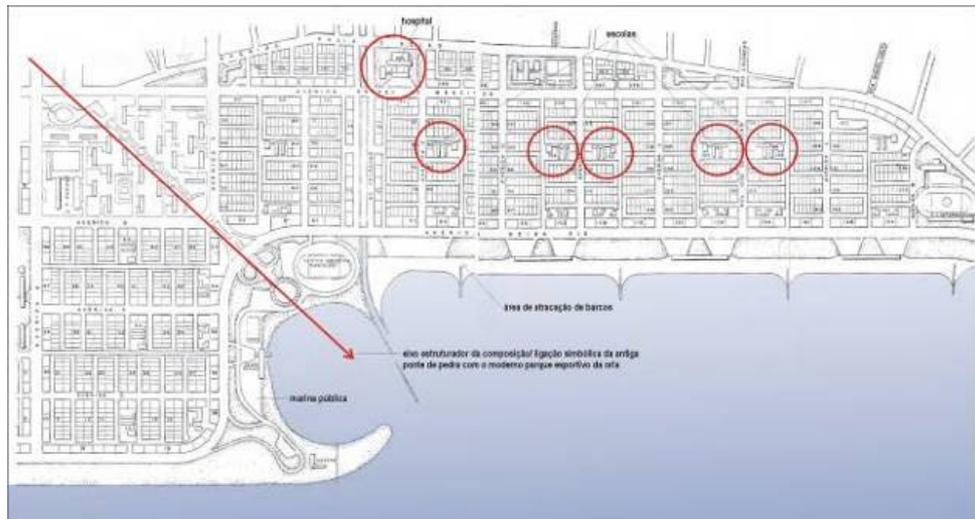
Plano Diretor de Porto Alegre (1959/1961). Planta do Projeto Praia de Belas.
